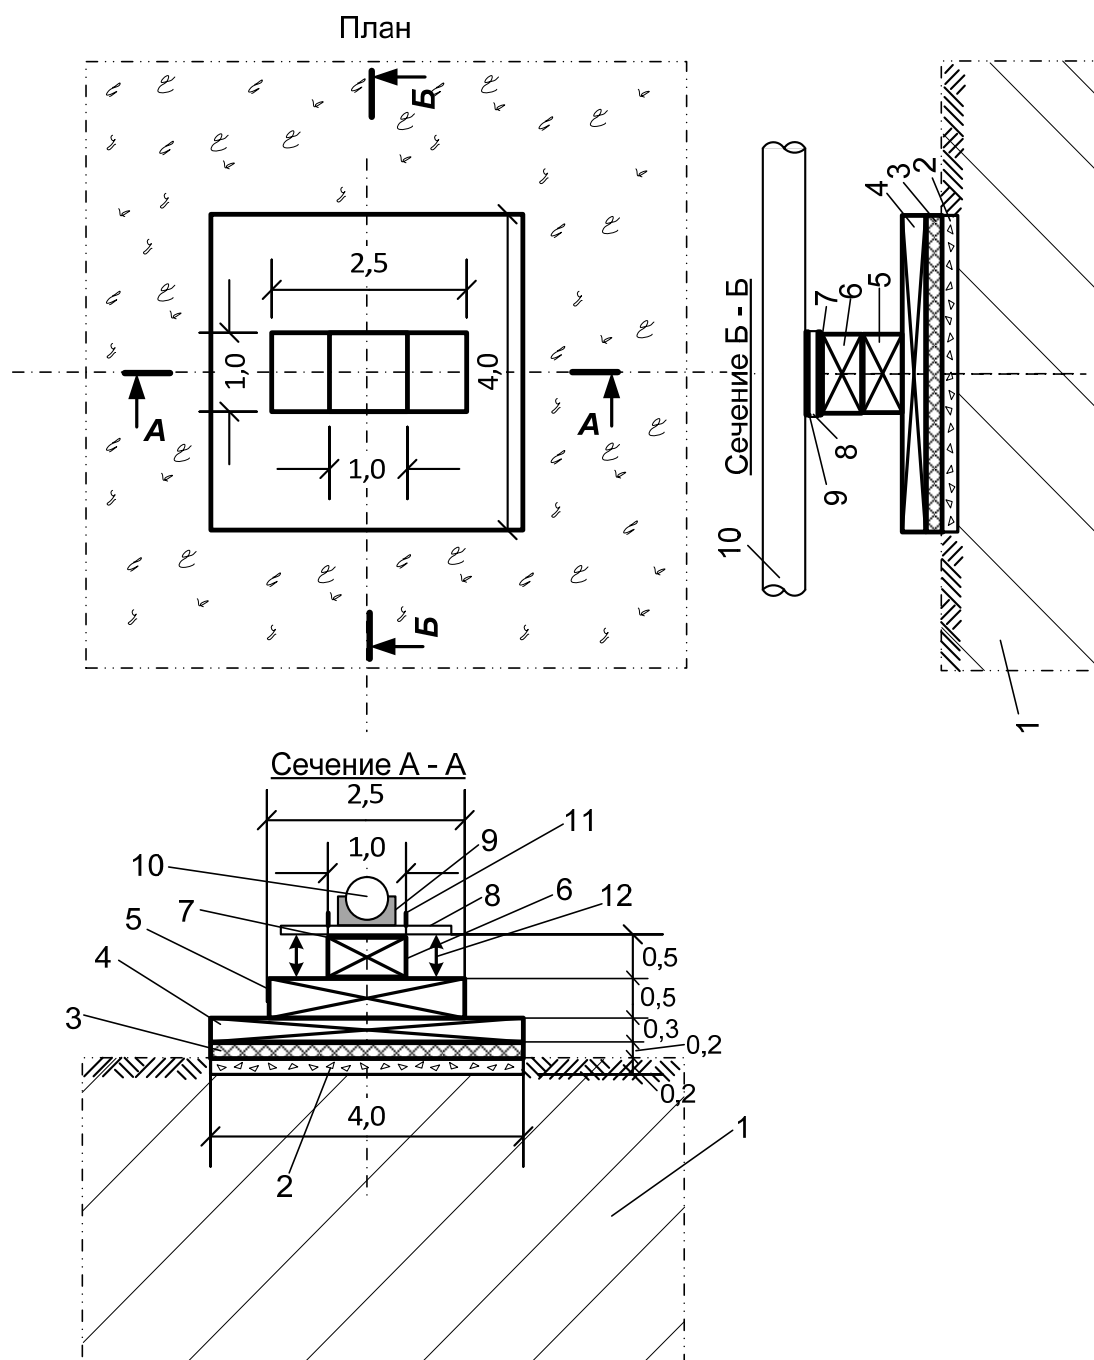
Схема опоры для нефтепровода: 1 – основной грунт, 2 – щебеночная подушка, 3- пенополистирол, 4 – габионная опорная плита, 5 – распределительная плита, 6 – тело опоры, 7 – прокладка (одна или несколько) для регулирования уровня нефтепровода при неровностях рельефа, 8- опорная плита, 9-кондуктор для фиксации нефтепровода, 10- нефтепровод, 11- упоры для ограничения горизонтального перемещения кондуктора 9 по опорной плите 8, 12 – домкраты для осуществления установки прокладок 7 в процессе осадки во время эксплуатации нефтепровода
